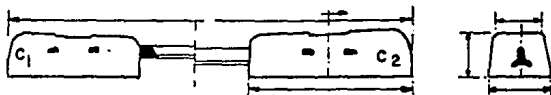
Durmiente de concreto formado por dos piezas unidas mediante una barra de acero.
